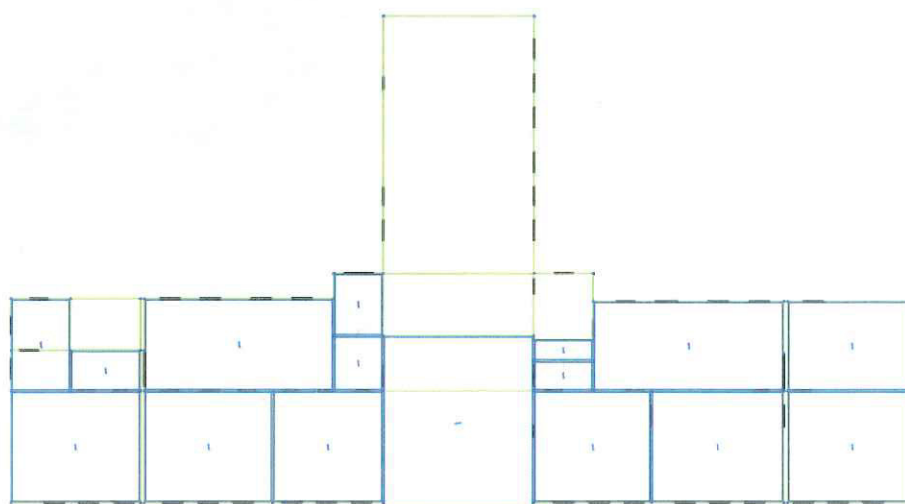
Vista in pianta delle geometria delle pareti piano terra
